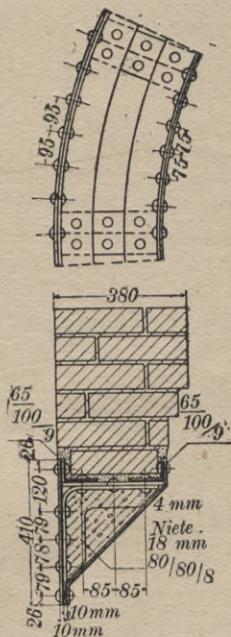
Eiserner Brunnenkranz mit Betonausfüllung.
